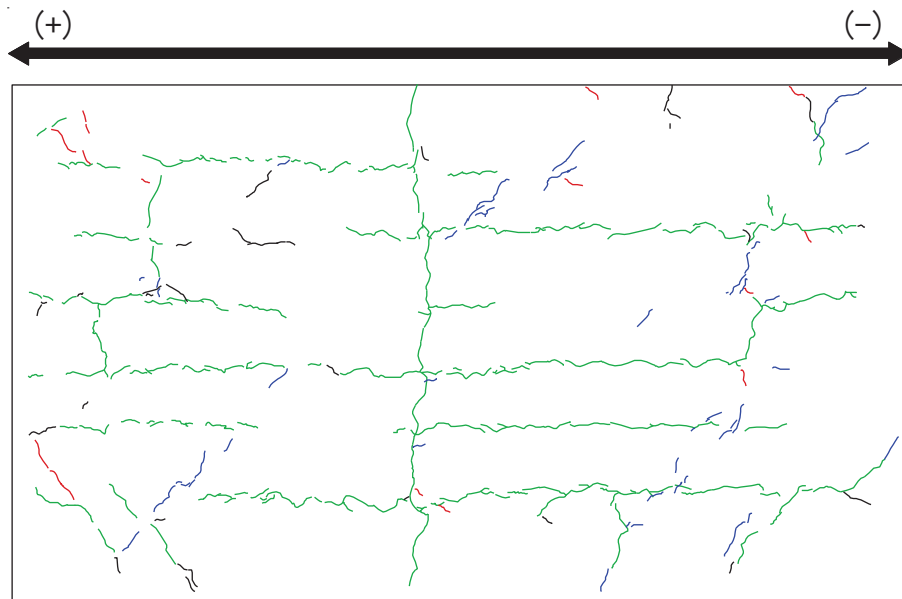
(4) 乾燥試験体 [1] 1/3333rad. におけるひび割れ図
